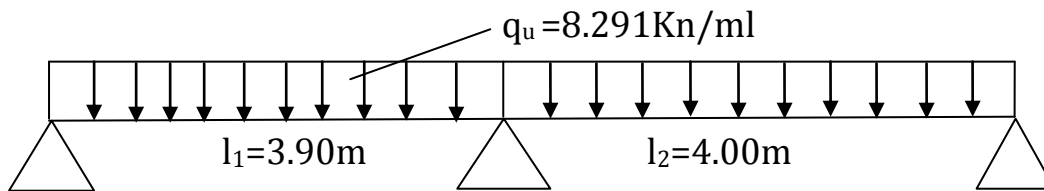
Schéma statique de la poutre continue reposant sur trois appuis.
